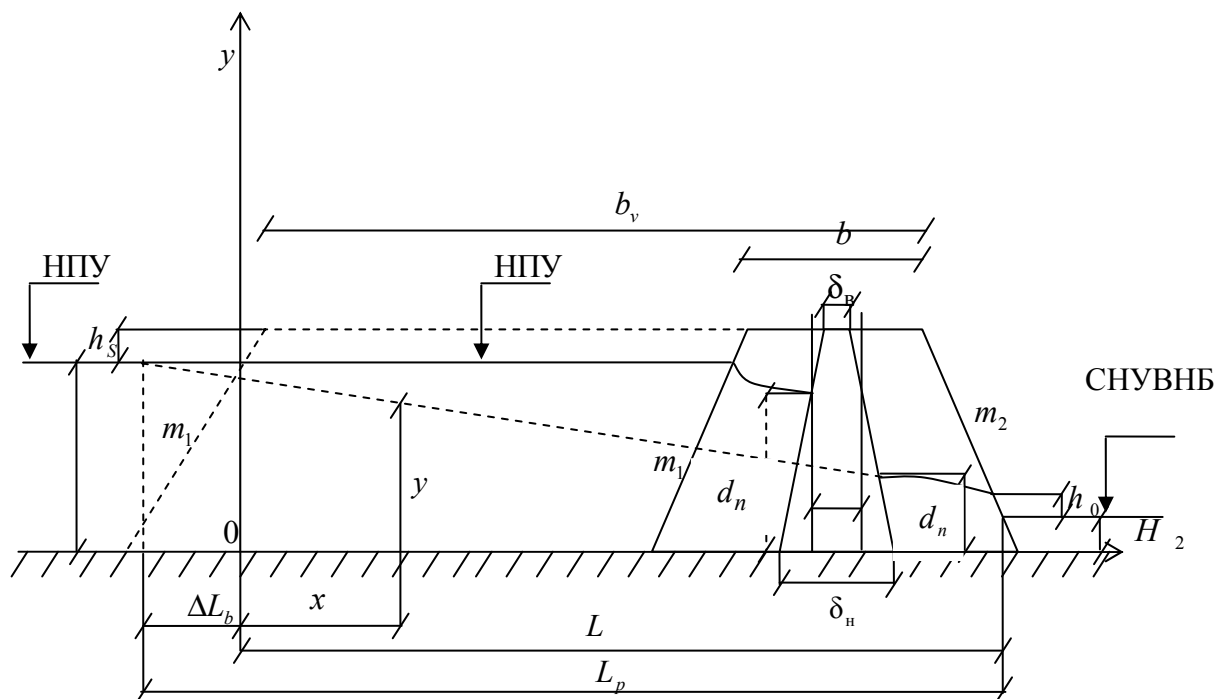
Схема к расчету через грунтовую плотину с ядром
